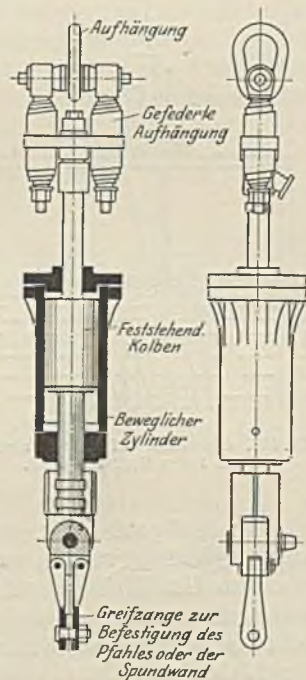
a. Schnitt durch den beweglichen Zylinder. Abb. 162 b. Seitenansicht des Zylinders mit Aufhängenvorrichtung.
